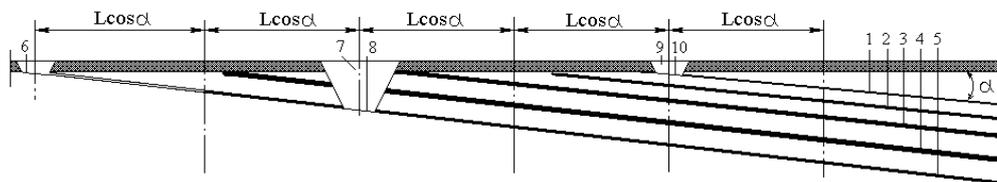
Заключительный этап отработки свиты пластов: 1—5 — пласты свиты; 6 — первая рабочая площадка; 7 — вторая траншея; 8 — вторая рабочая площадка; 9 — третья траншея; 10 — третья рабочая площадка; L — длина проводимой выработки; α — угол залегания пласта
